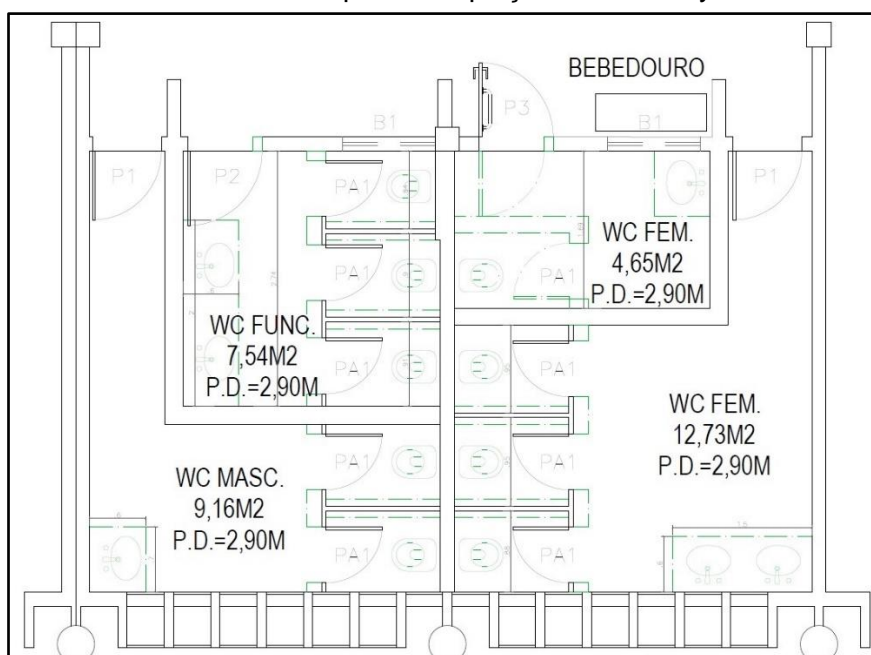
Bloco 1 – Reforma dos wc's nível 2 - Serão executadas obras de elétrica, substituição de revestimentos e aparelhos hidrossanitários, para viabilizar a implantação de novo layout.
